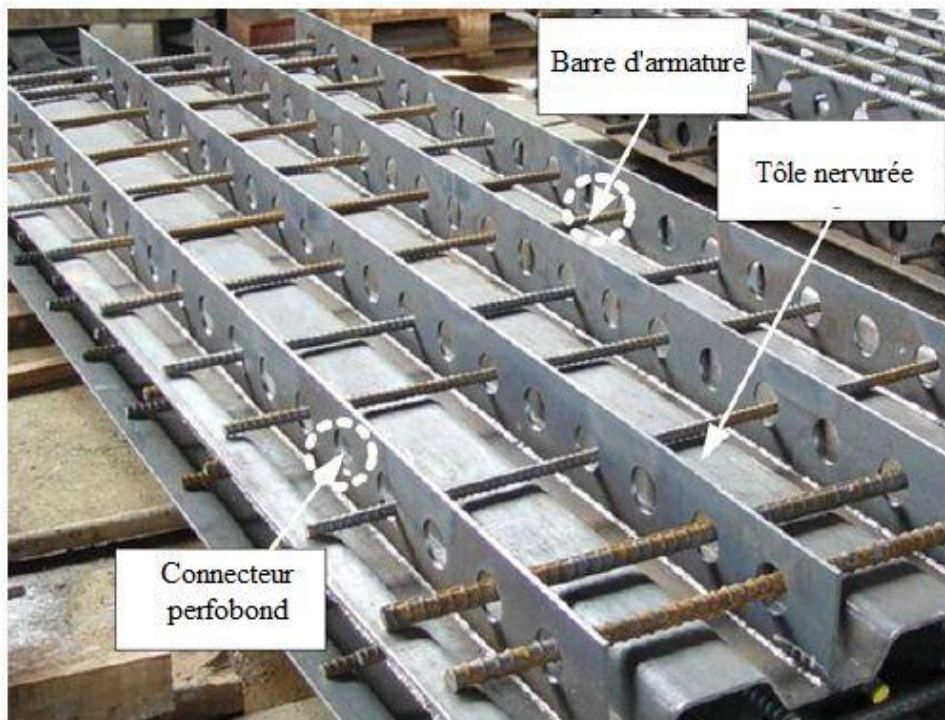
Connecteur perfobond muni de barres additionnelles dans les trous.
